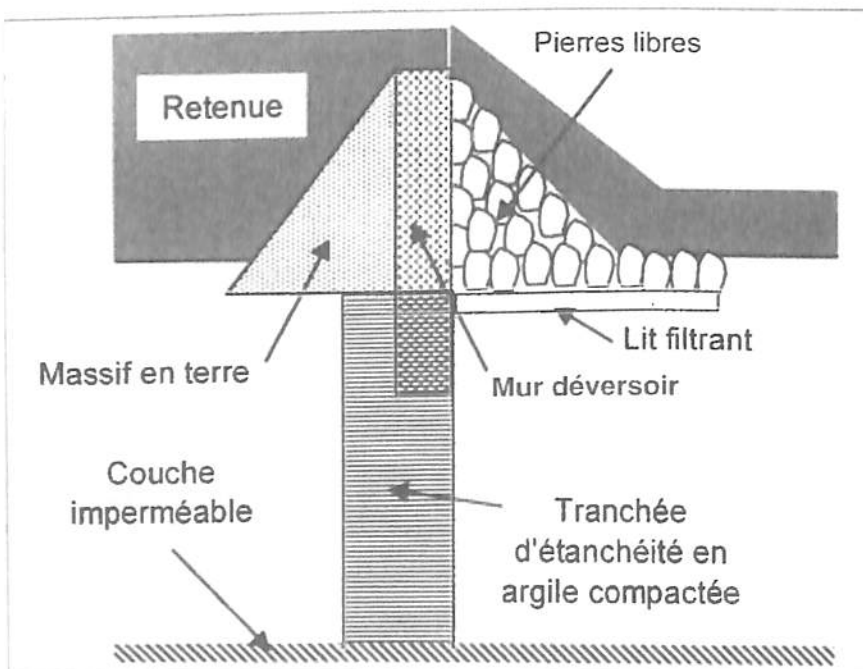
Schéma d'une digue déversante avec tranchée d'étanchéité.
